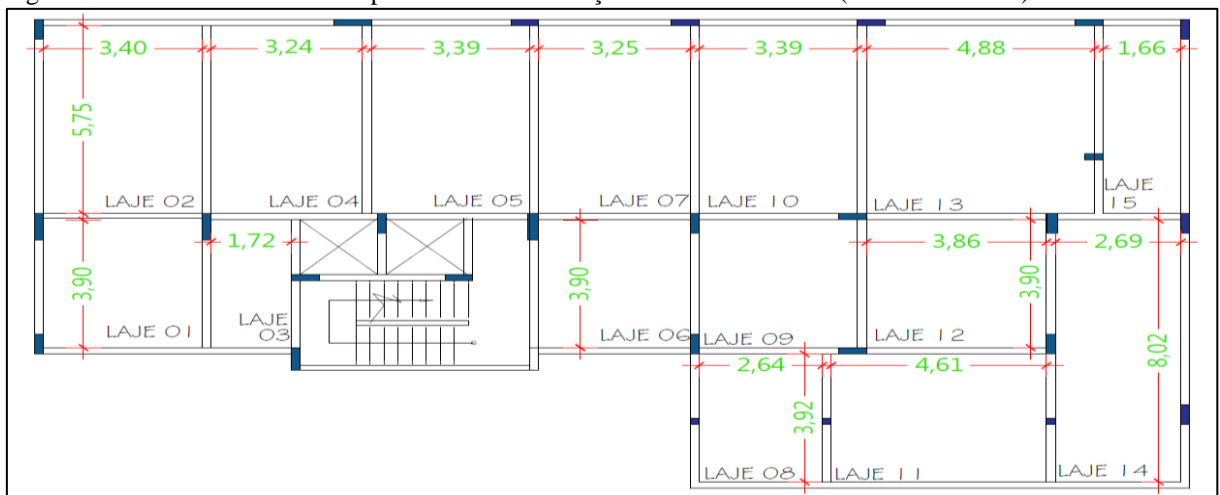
Planta de fôrma do 2º pavimento com vedações internas em drywall (cotas em metros)
